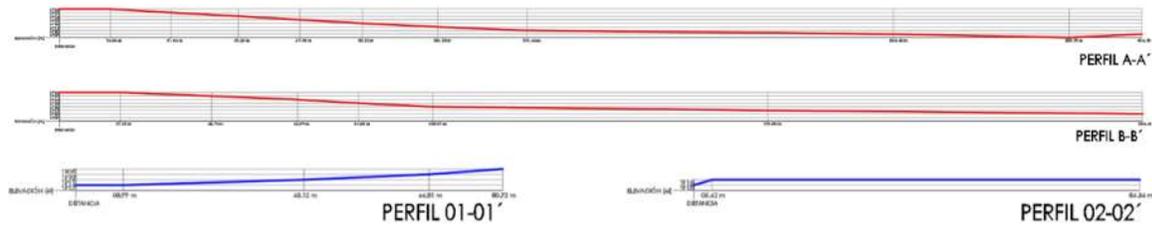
| Levantamiento Topográfico del Terreno, Perfiles.
